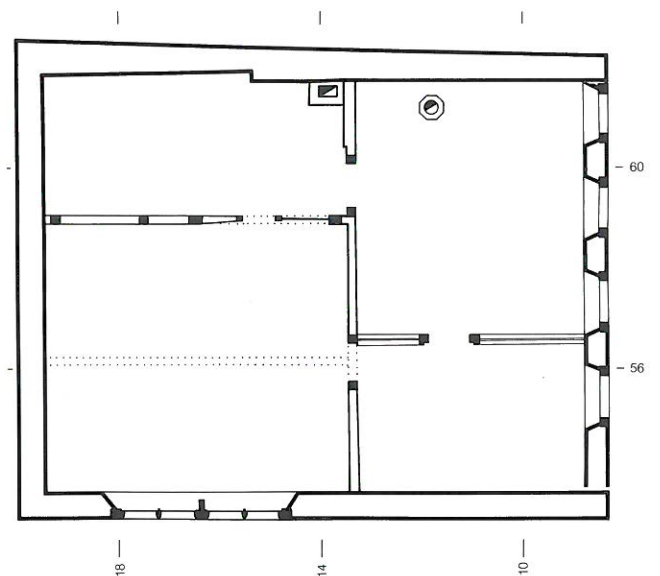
Unterseen - Obere Gasse 42. Grundriss des 2. Obergeschosses. M. 1:150.
